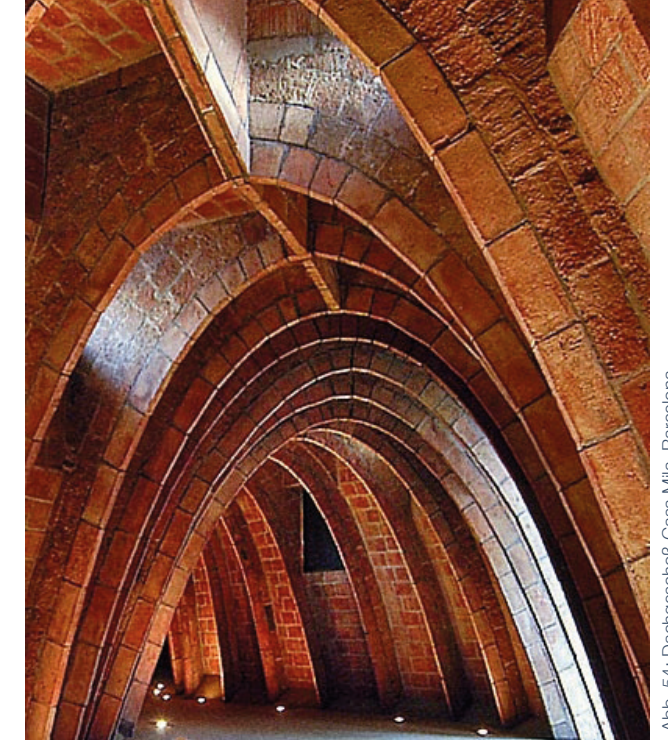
Dachgeschoß Casa Milà, Barcelona
